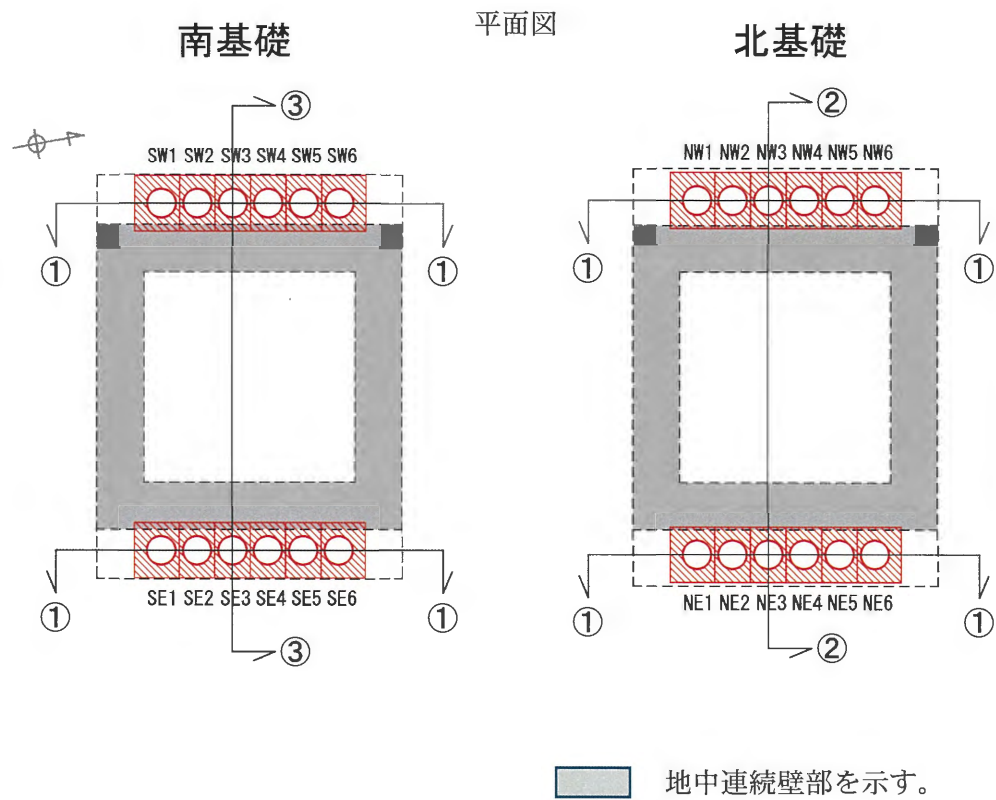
評価位置図（巻立て鉄筋コンクリート）
